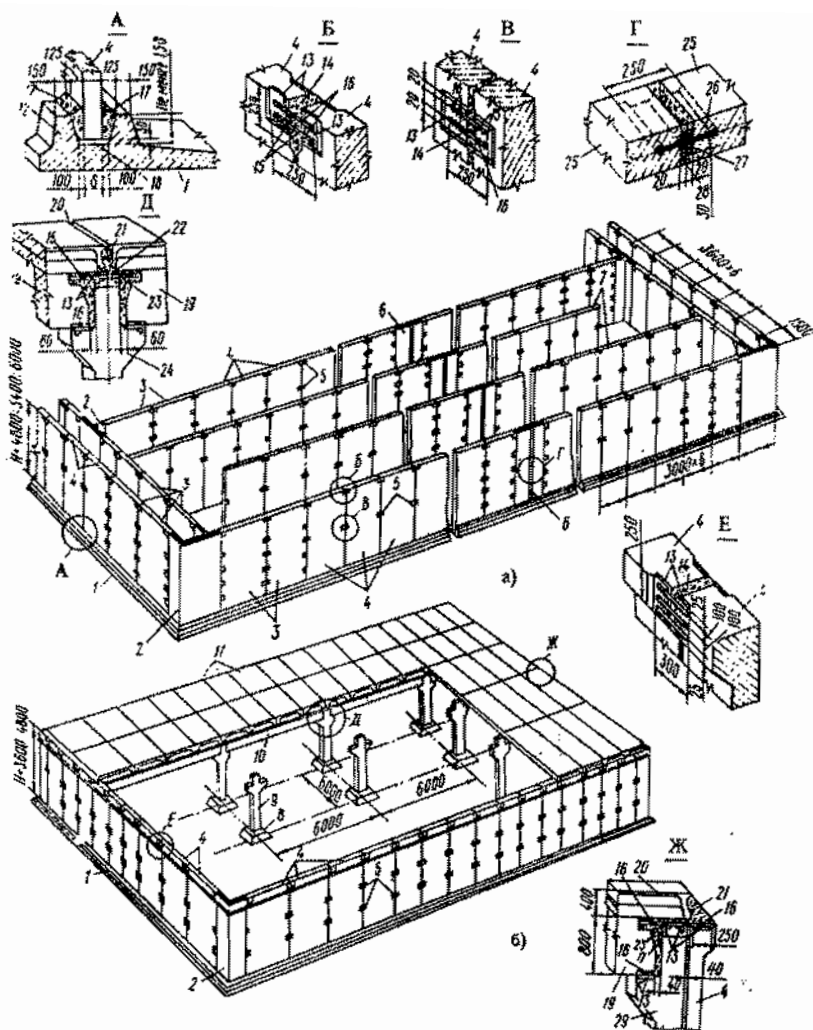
Конструктивно-монтажные схемы прямоугольных емкостных сооружений из типовых унифицированных сборных элементов и деталей: а - емкостное прямоугольное сооружение коридорного типа (азротенки, горизонтальные отстойники и др.); б - резервуар; 1 - монолитное днище; 2 - монолитные угловые участки стен; 3 - панели для угловых участков; 4 - рядовые панели; 5 - закладные детали стыков; 6 - температурно-усадочный или деформационный шов; 7 - перегородочные панели; 8 - фундаменты (подколонники); 9 - колонны; 10 - балки или ригели; 11 - плиты покрытия; 12 - паз для установки стеновых панелей; 13 - закладные детали; 14 - цементно-песчаный раствор М300; 15 - накладные стержни; 16 - монтажные сварные швы; 17 - бетон М300 на мелком заполнителе; 18 - выравнивающий слой цементного раствора; 19 - балки или ригели; 20 - плиты покрытия; 21 - бетон М200 на мелком заполнителе; 22 - пластина металлическая; 23 - стержни; 24 - колонны рядовые; 25 - монолитные участки стен или днища; 26 - резиновая трехкулачковая шпонка; 27 - асбестовая пряжа, пропитанная битумом; 28 - асбестоцементный раствор; 29 - колонны пристенные
